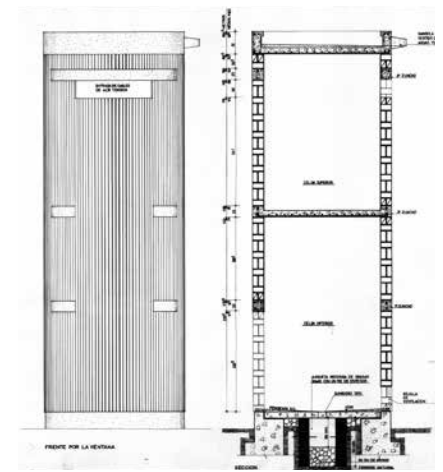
Nave de Tableros Aislantes. Plano de obra del detalle arqueta-sumidero de la torre exterior.
